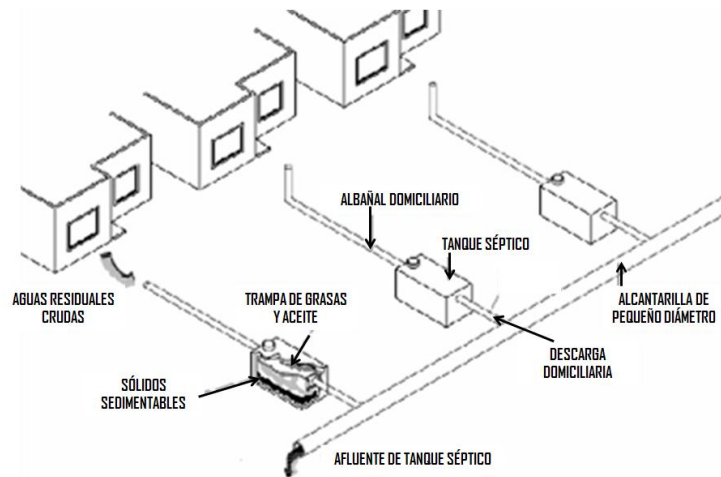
Alcantarillado sin arrastre de sedimentos.
